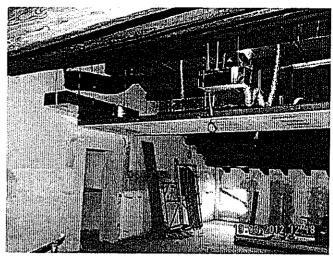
Stanza 2.1: Salone centrale- vista tetto e impianti meccanici
